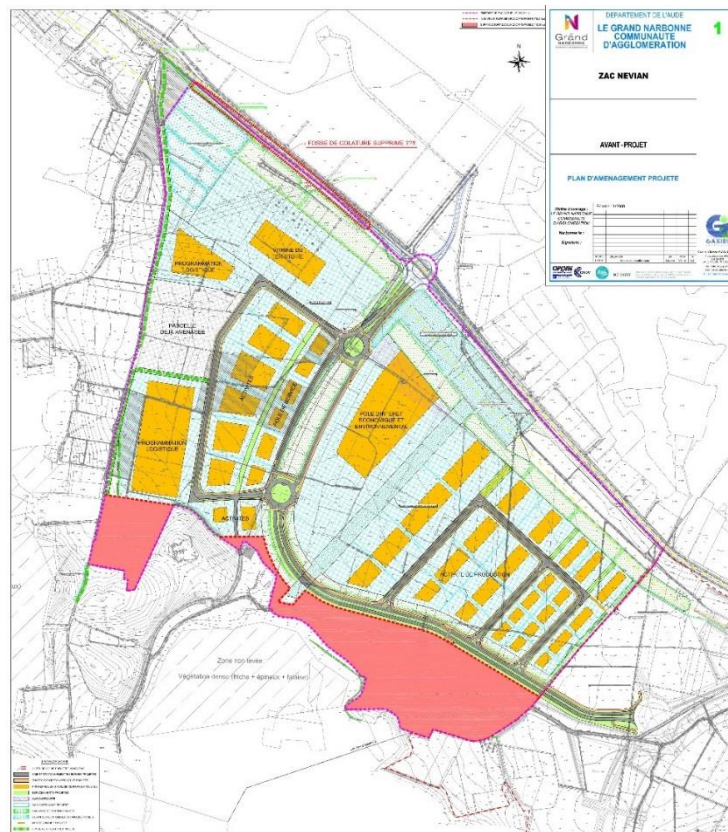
Plan d'aménagement de la ZAC de Néviau
